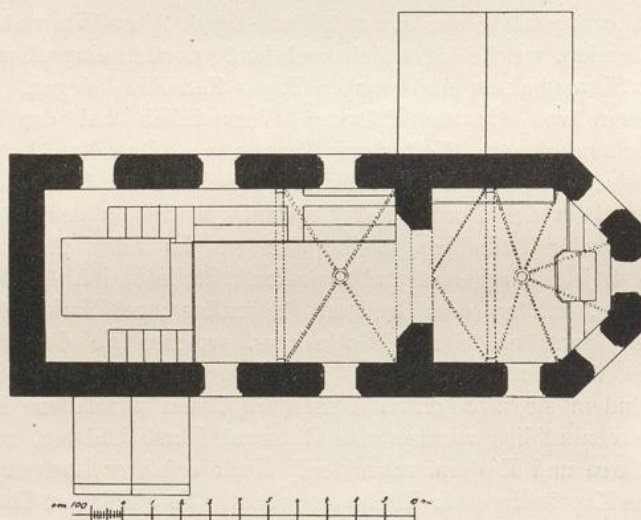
Kirche in Kirchhorst; oberer Grundriss vor der Wiederherstellung.
